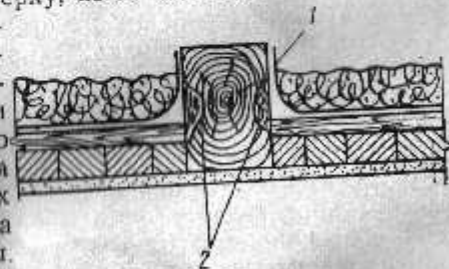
Пример неправильной укладки пароизоляционного слоя в чердачном перекрытии
